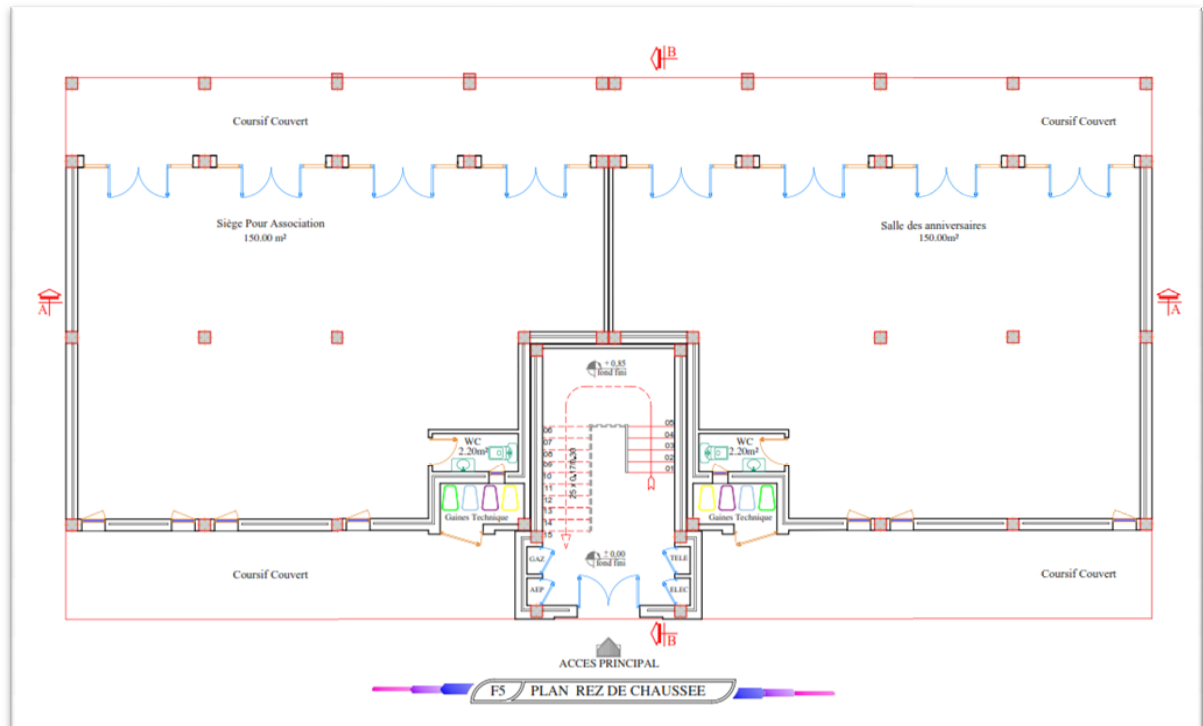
Plan de Rez de Chaussée. Type.02.
